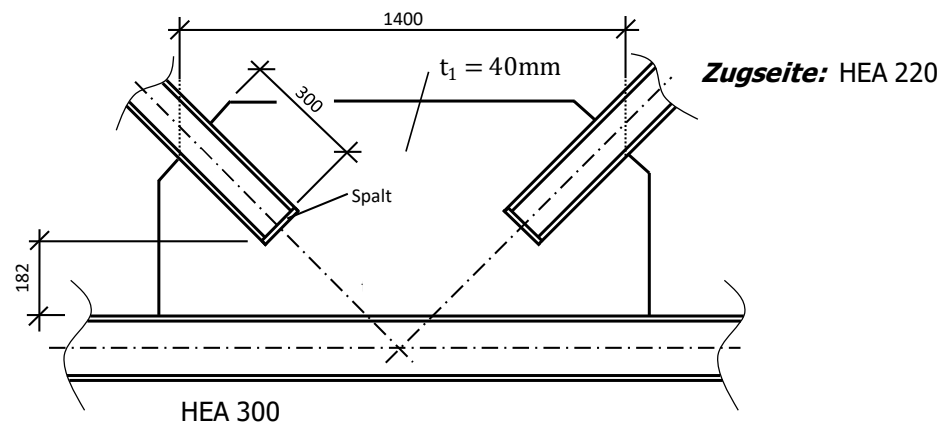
Knotendetail des Strebenfachwerkanchlusses nach [15]
